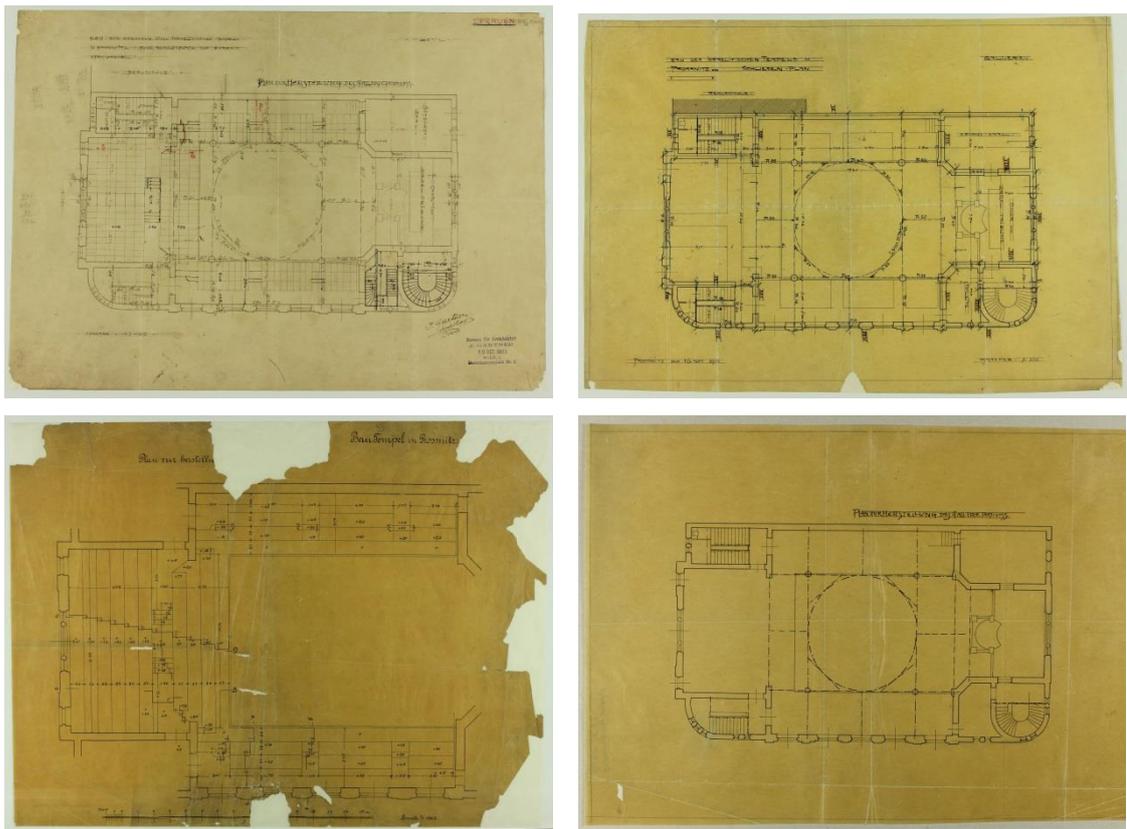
Grundrisse Synagoge Prostějov
